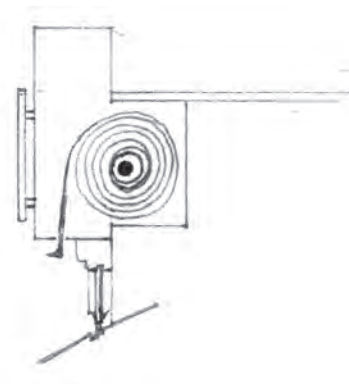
24. 1988 DETALLE CONSTRUCTIVO DE CAJA DE PERSIANA ²
